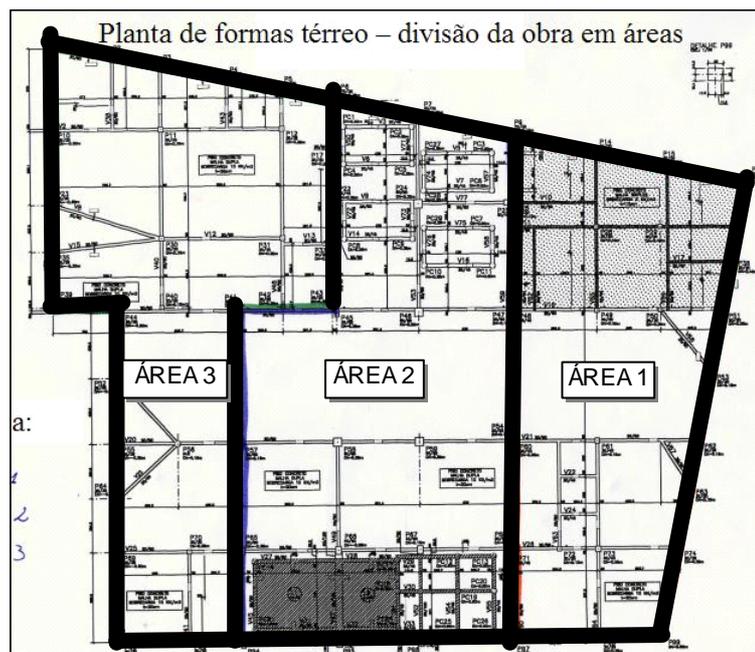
divisão do projeto em áreas, conforme plano de ataque a obra
